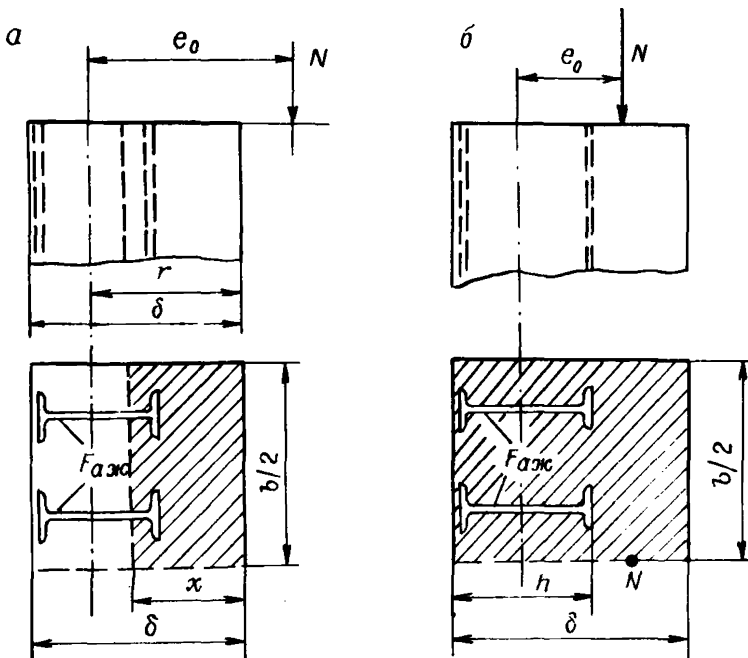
К расчету железобетонной крепи с жесткой арматурой:
